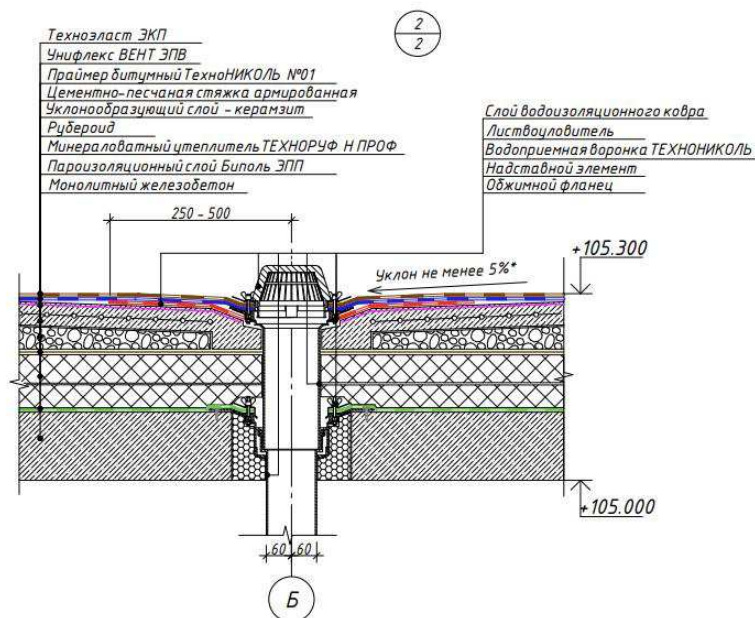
Устройство примыкания кровельного ковра к водоприемной воронке
